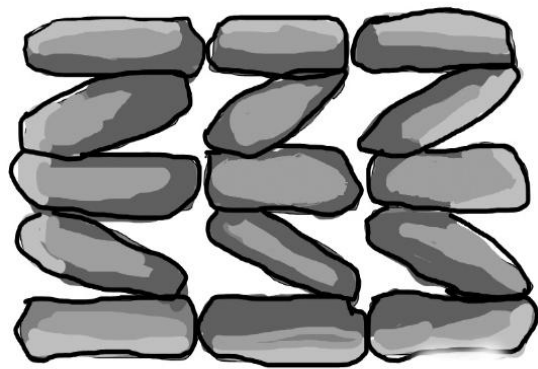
Representación de la vista cenital de un muro construido mediante la técnica de espina de pez.
